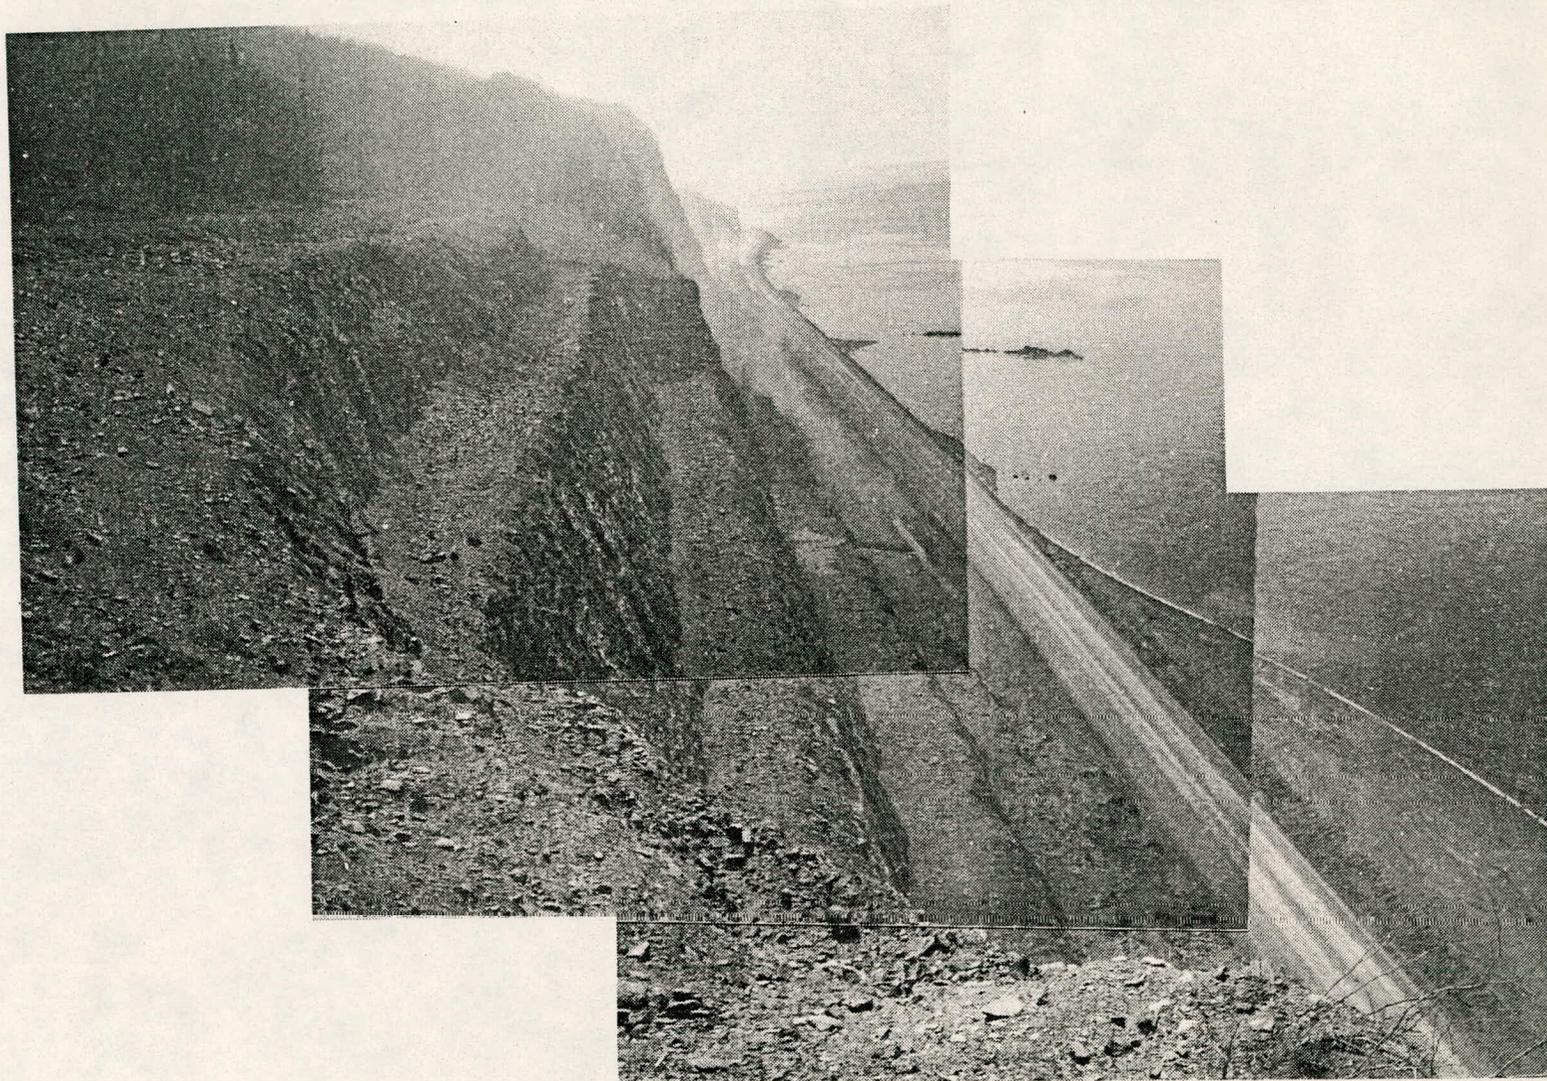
COUPE DE CINQ PALIERS LE LONG DE LA ROUTE 132 ENTRE LA MARTRE ET MARSOUI. PHOTOGRAPHIE PRISE À LA FIN DE LA PÉRIODE DE CONSTRUCTION.
